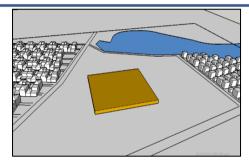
suasana view arah barat site Sumber : foto pribadi
